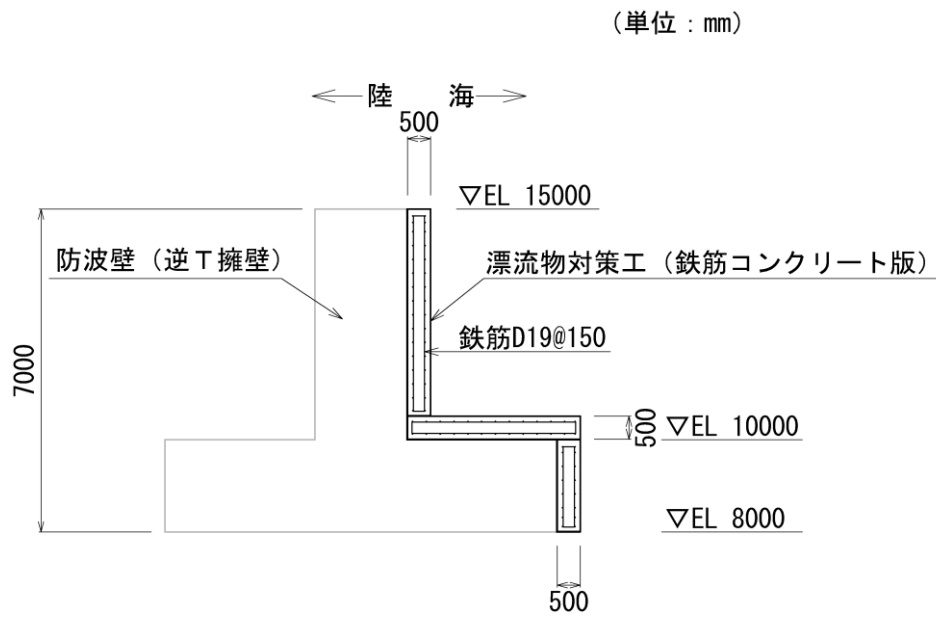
(2) 漂流物対策工 (鉄筋コンクリート版) の概略配筋図 (断面図)
